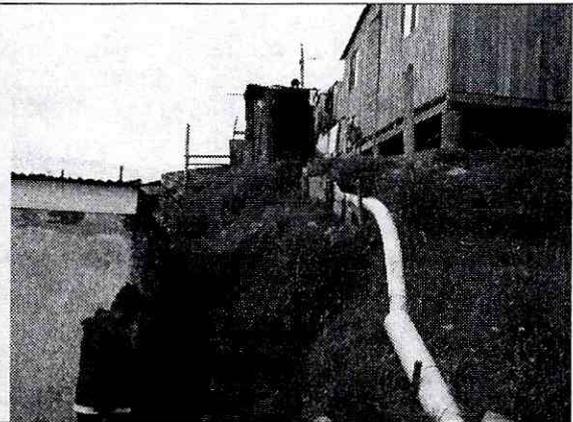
Vista del costado lateral (occidental) de la vivienda ubicada en la Calle 82A Sur # 18N-52. El terreno del talud de corte hacia este costado no cuenta con medidas de estabilización, ni manejo de drenaje superficial y subsuperficial
